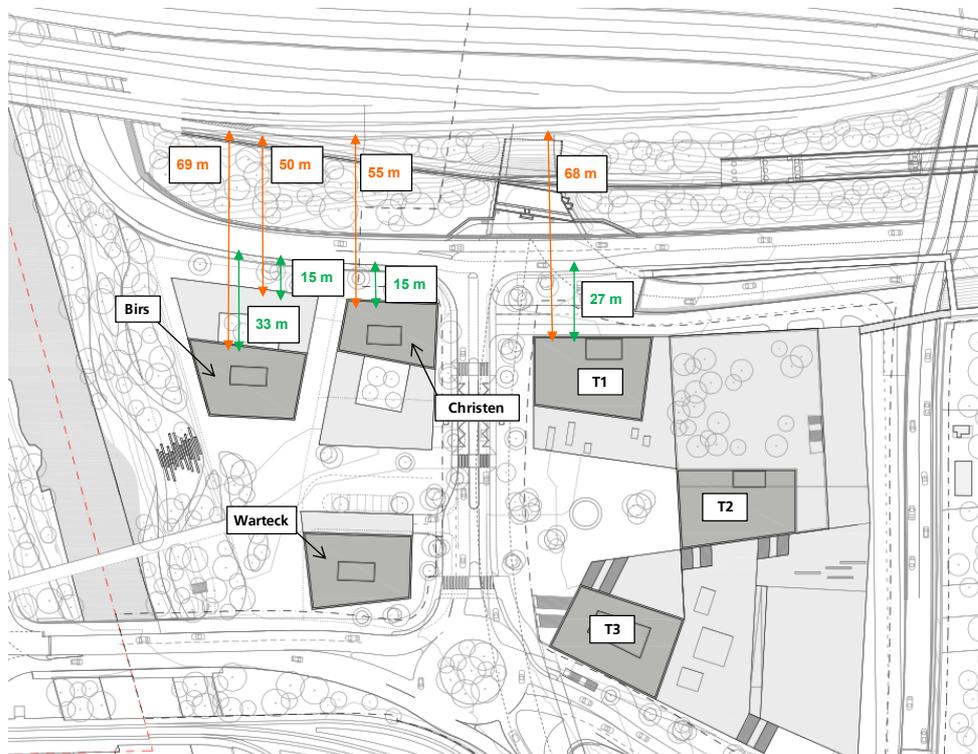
Lage der relevanten Gebäude bzw. Fassaden und Abstände zu den störfallrelevanten Verkehrsachsen.
